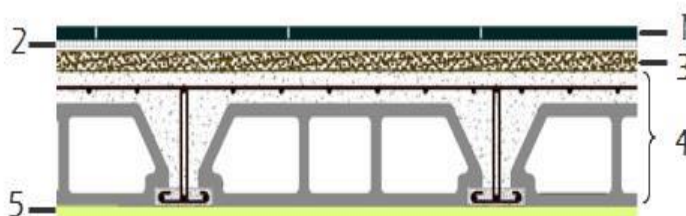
Coupe d'un plancher d'étage courant en corps creux.
